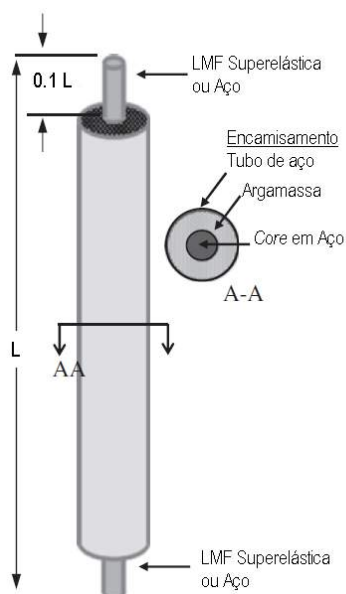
Estrutura dos sistemas BRB propostos por Hu et al.[11]
